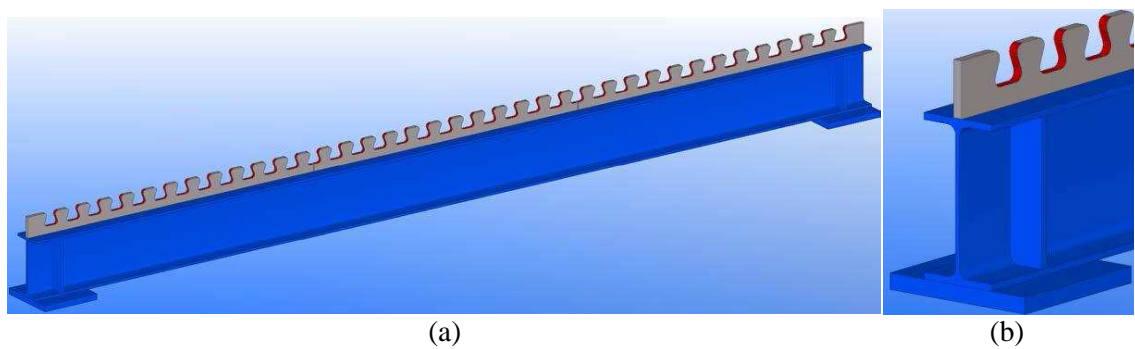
Esquemas tridimensionais: (a) viga metálica reforçada com chapas e conector de cisalhamento CR40; (b) Detalhe da região de apoio (ALVES, 2014).
